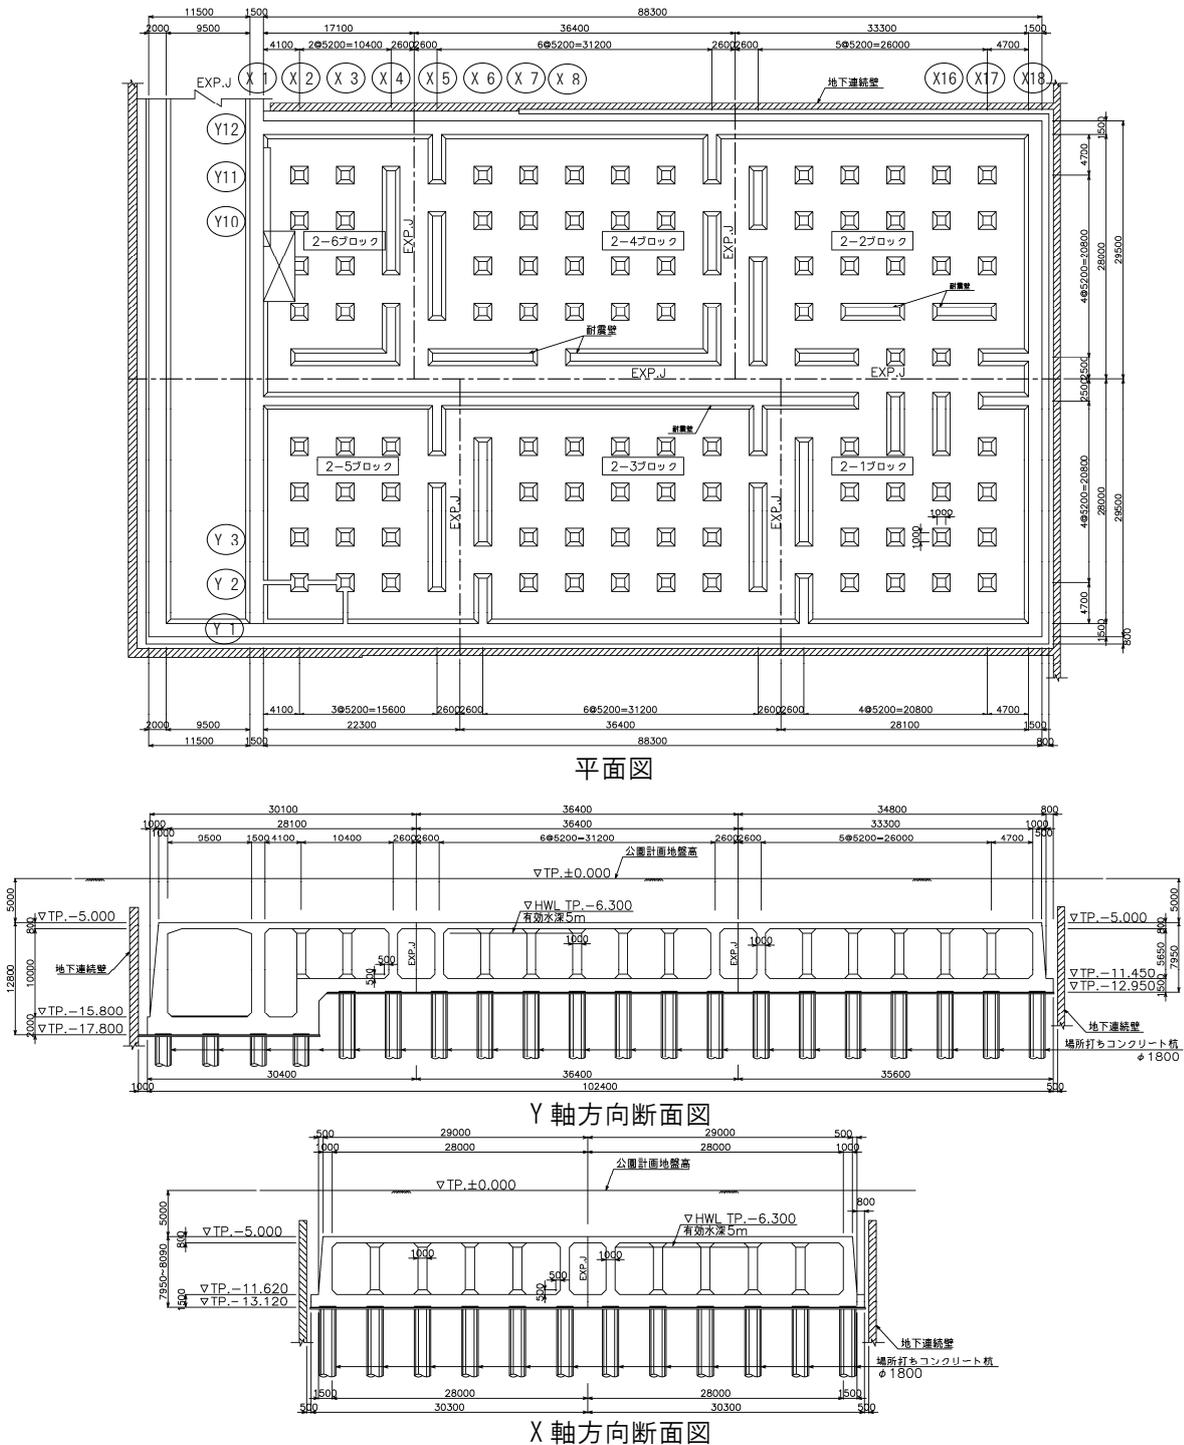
2号配水池構造図(上から平面図、Y軸方向断面図、X軸方向断面図)
